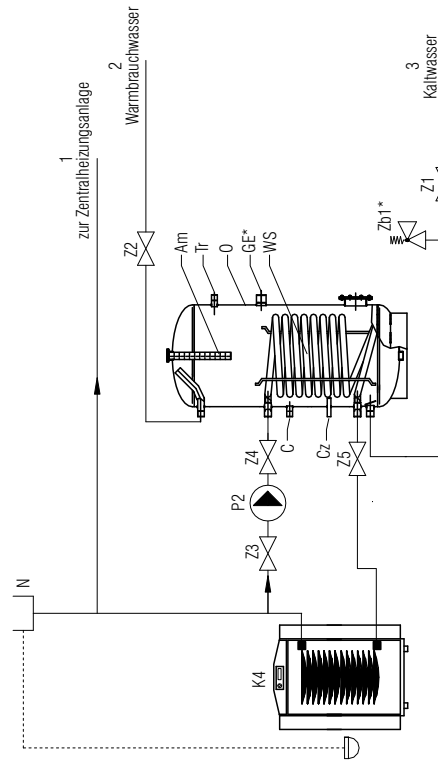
Montageplan des Wasser-Heizgerätes an den geöffneten Kreislauf
